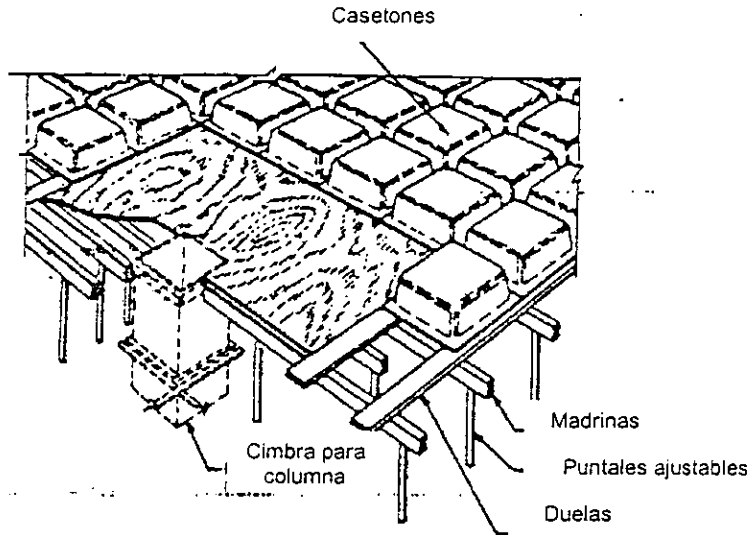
Cimbra para entepiso aligerado con casetones
